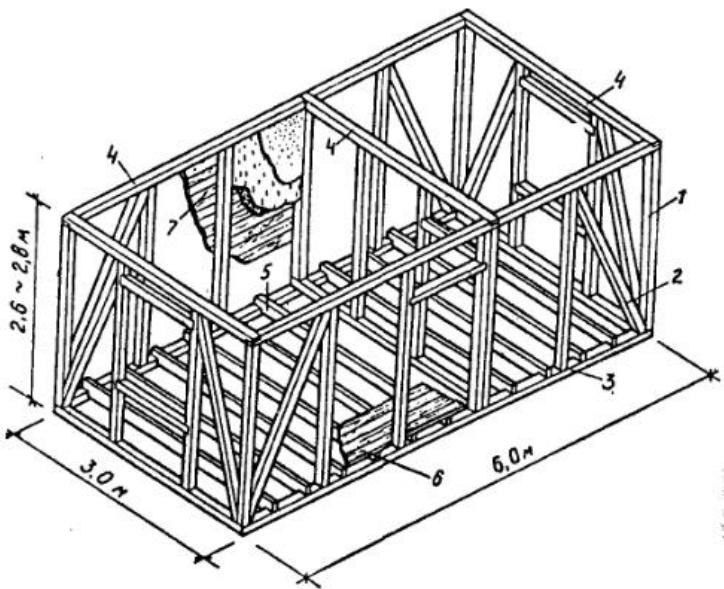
Монтажная схема деревянных стен каркасной конструкции: 1 — стойка; 2 — раскос; 3 — нижняя обвязка; 4 — верхняя обвязка; 5 — балка перекрытия; 6 — половая доска; 7 — обшивка (заполнение) стен (стругальная доска снаружи, утеплитель, пергамин, ДВП — внутри).
